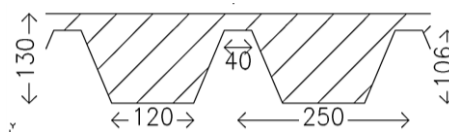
Pormenor de laje colaborante (Fonte: Cypecad, 2015)
